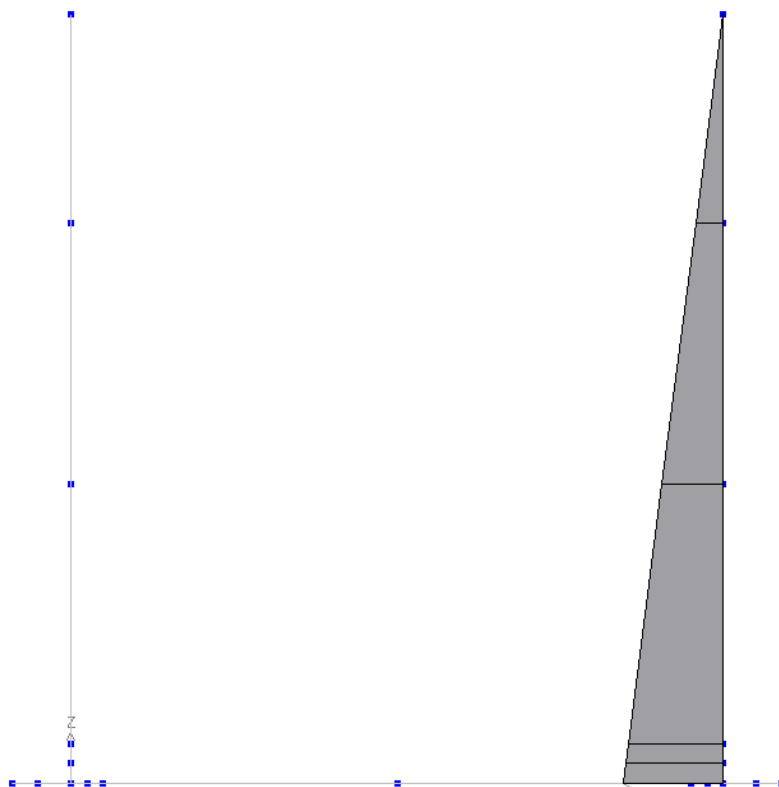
SPINTA A RIPOSO DELLE TERRE SUL PIEDRITTO DESTRO (CDC 4)
